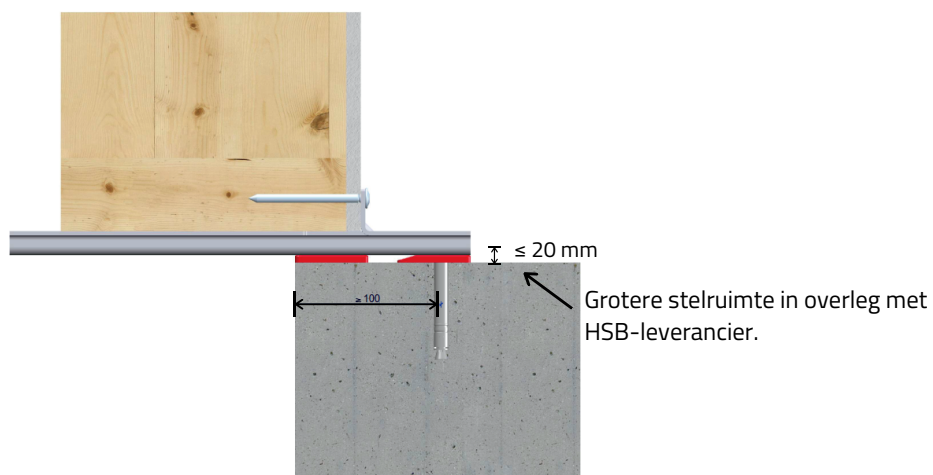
Bevestiging T02-anker onderzijde HSB-wand.
